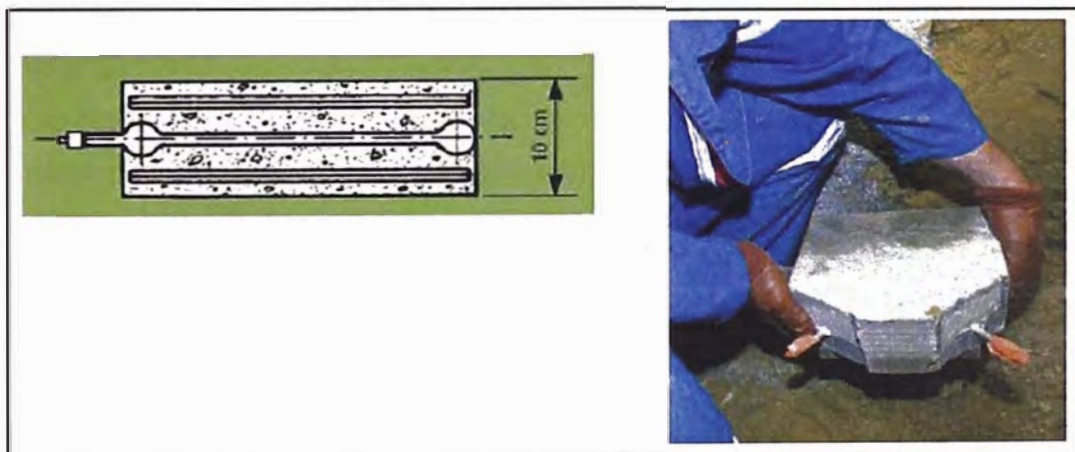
Pistón plats incrustado dentro del bloc de concreto.
